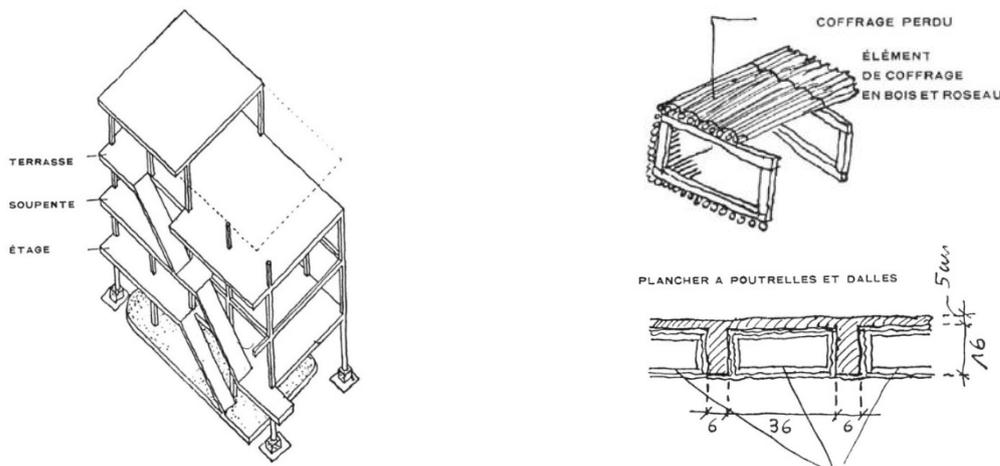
A la izquierda, axonometría de la estructura de la vivienda unifamiliar. A la derecha, una sección del forjado aligerado y un esquema del encofrado perdido.
